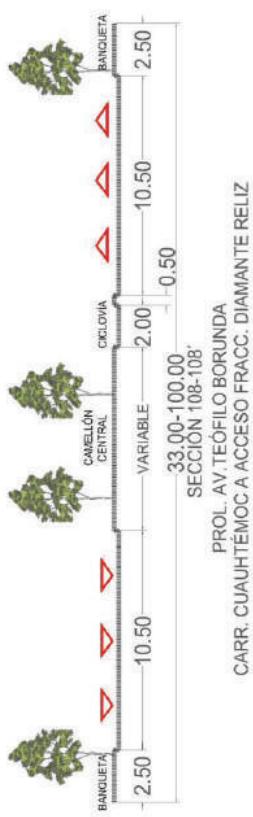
Secciones Viales del Plan Parcial 3 Presas o en su defecto, del Plan de Desarrollo Urbano 2040.
